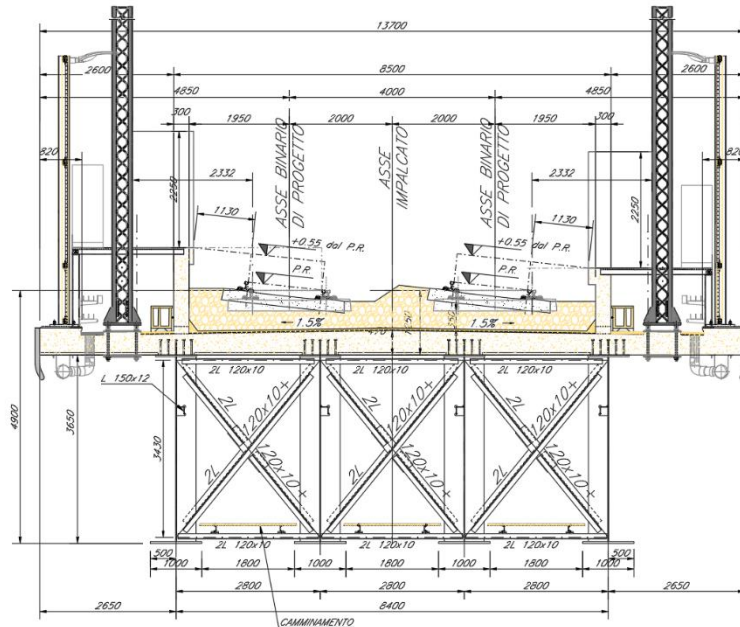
Sezione trasversale tipo (H travi = 3.65 m)
